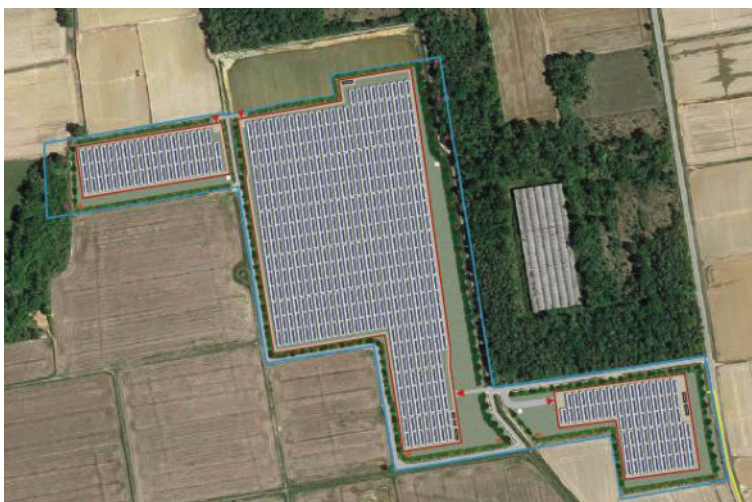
Layout del campo fotovoltaico e dettaglio delle opere di mitigazione, estratto da R_7.1_ROA_OMA_0-Opere di mitigazione e compensazione ambientale_R1 Rev. 2 – luglio 2025
